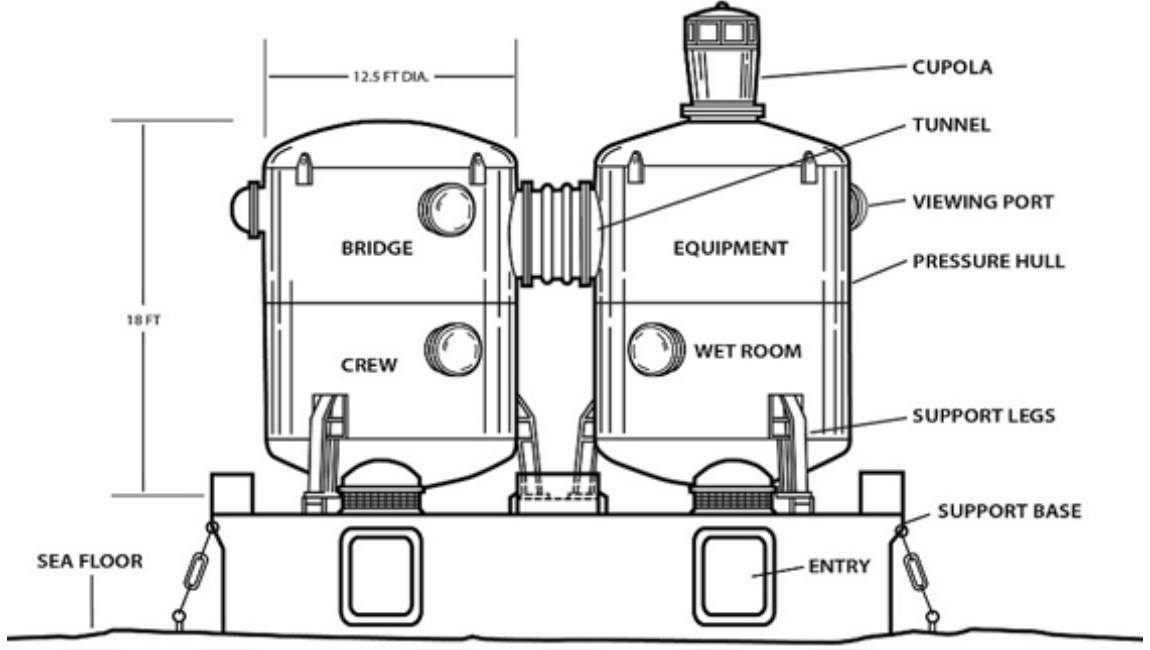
Aegir plan ve kesit çizimi [54]
